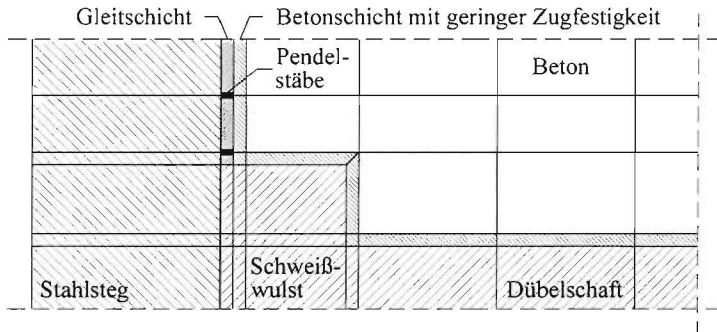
Modellierung der Kontaktflächen nahe der Schweißwulst
